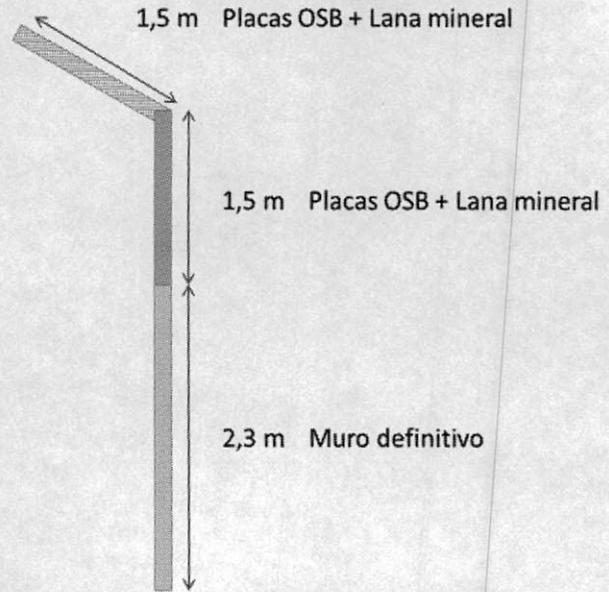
Cierre perimetral propuesto para poniente oriente del proyecto.
